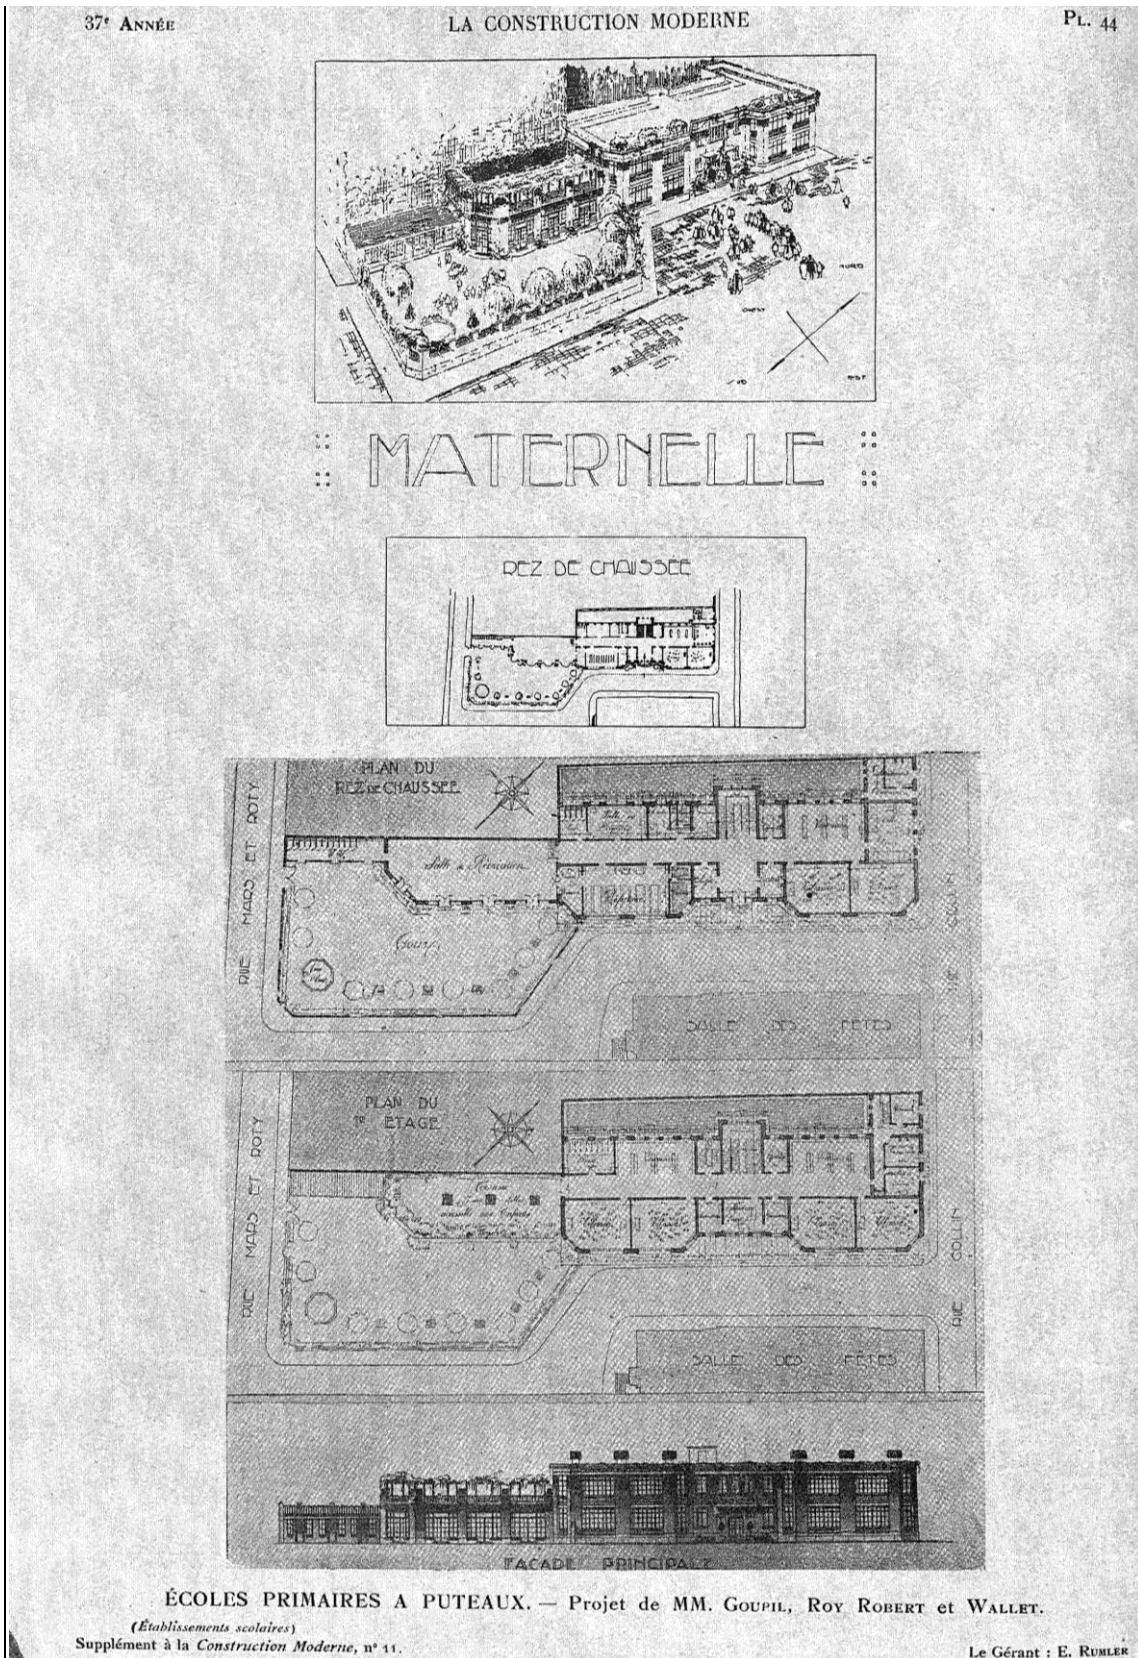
École primaire à Puteaux. — Projet de M.M. Goupil, Roy Robert et Wallet. *La Construction Moderne*, 11 décembre 1921, 37<sup>ème</sup> année, n°11, pl. 43.
